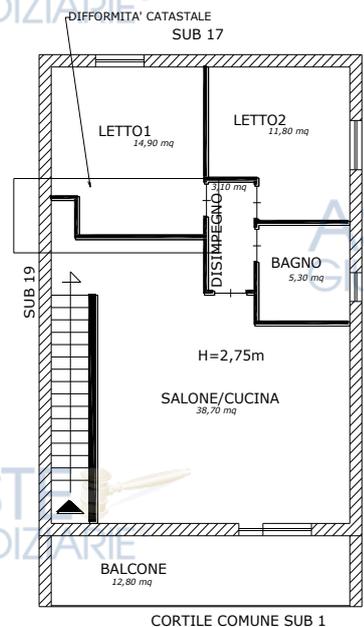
planimetria delle difformità catastali dell'appartamento al primo piano
